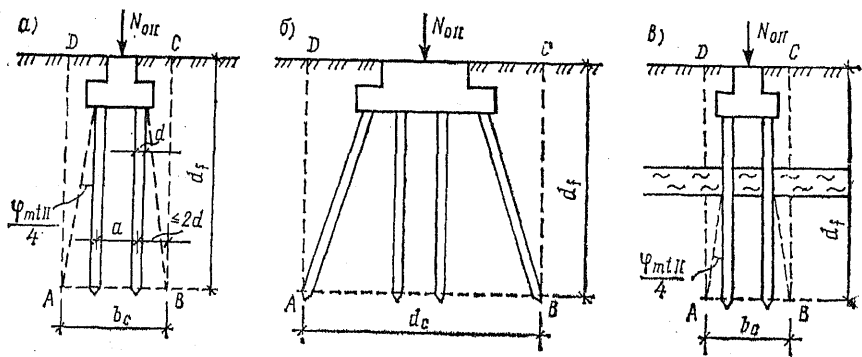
Схемы условных фундаментов для расчета осадки
